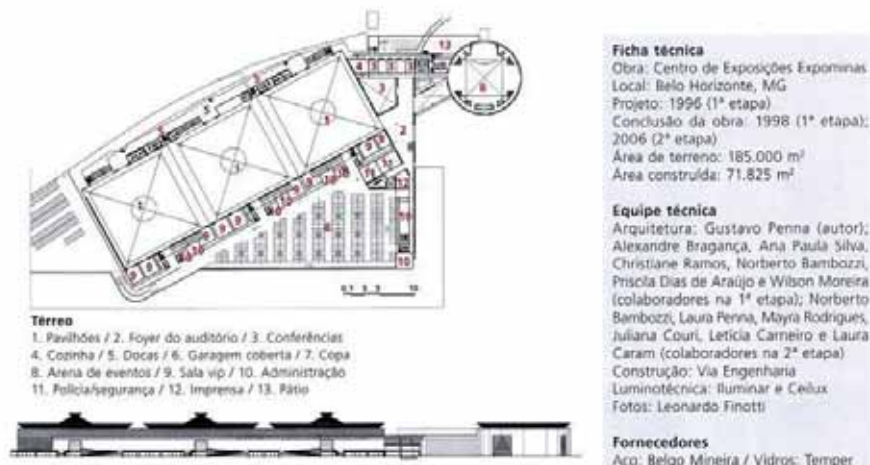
EXPO MINAS-Planta Térreo e um corte. Fonte: Revista FINESTRA47 - pag71.
